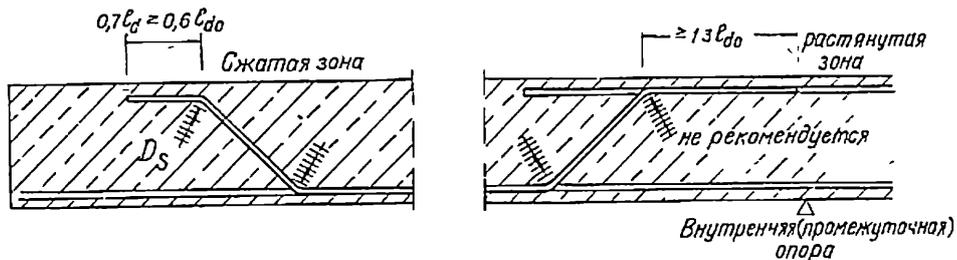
7. Поперечная арматура в зоне заделки стержней крупного диаметра, уложенных с обрывами
